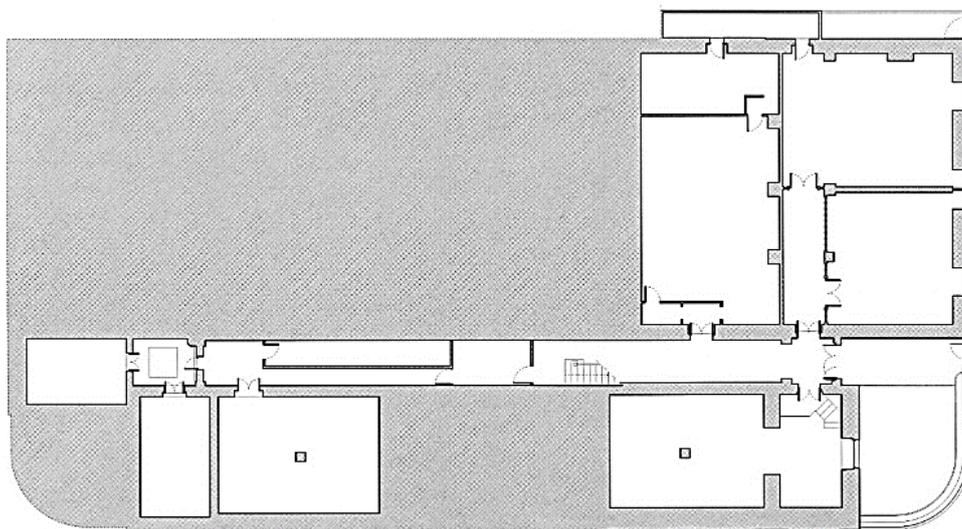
Planta do rés-do-chão da versão construída – Desenho do autor
